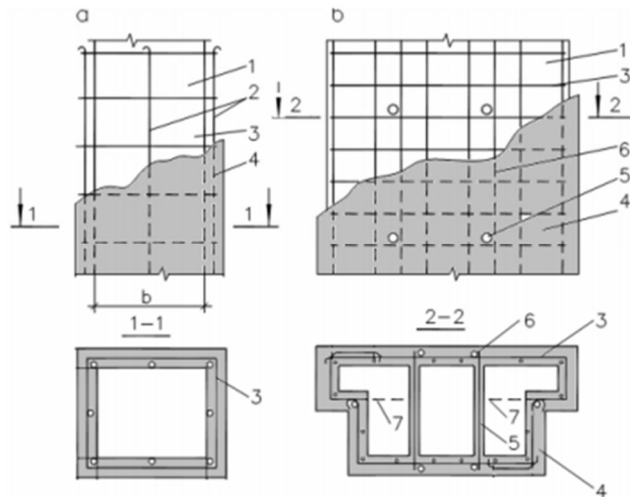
Посилення залізобетонними обоймами: а – стовпів, б – простінків: 1 – конструкція, що підсилюється, 2 – поздовжня арматура, 3 – поперечна арматура, 4 – бетон, 5 – додаткові поперечні зв'язки, 6 – поздовжня арматура, 7 – анкери.
